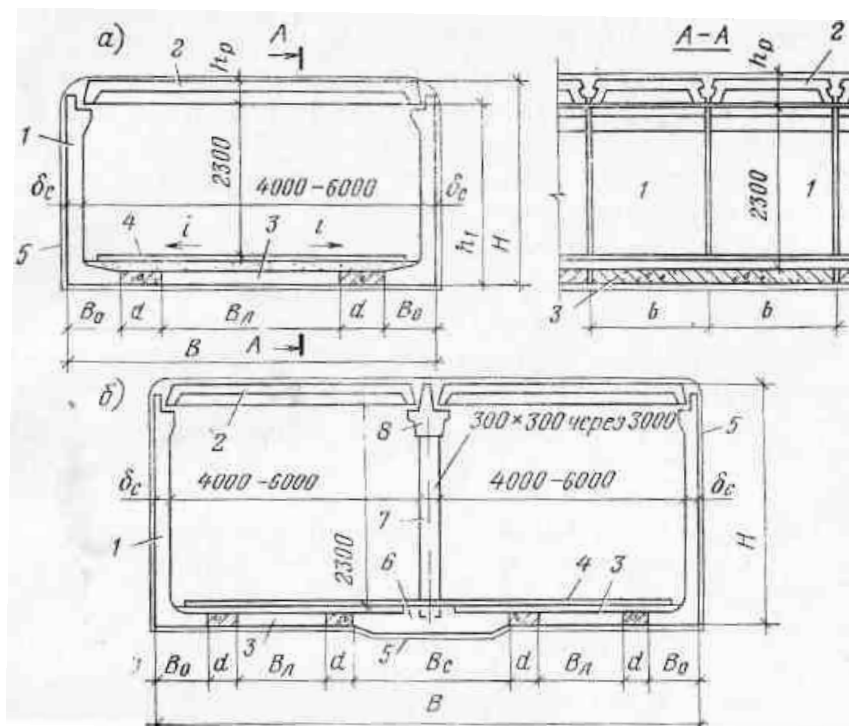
Конструкции однопролетного (а) и двухпролетного (б) пешеходных тоннелей из сборных железобетонных элементов:
